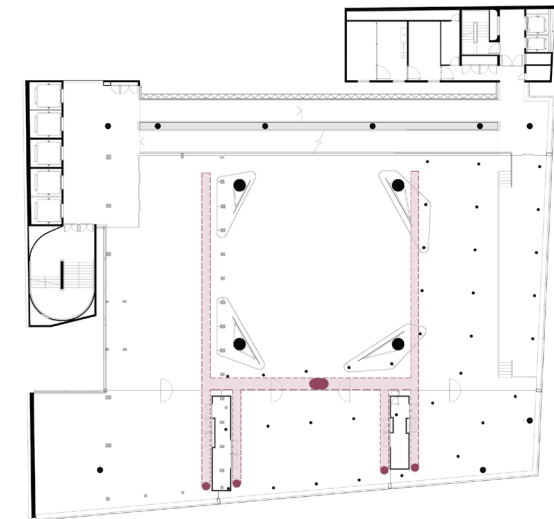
Esquema con indicación de cambio de subida de ductos de los cuatro de la fachada para los dos centrales. Indicado también los ductos horizontales del piso. (Autoría propia. 2021. Base: MMBB Arquitectos)
